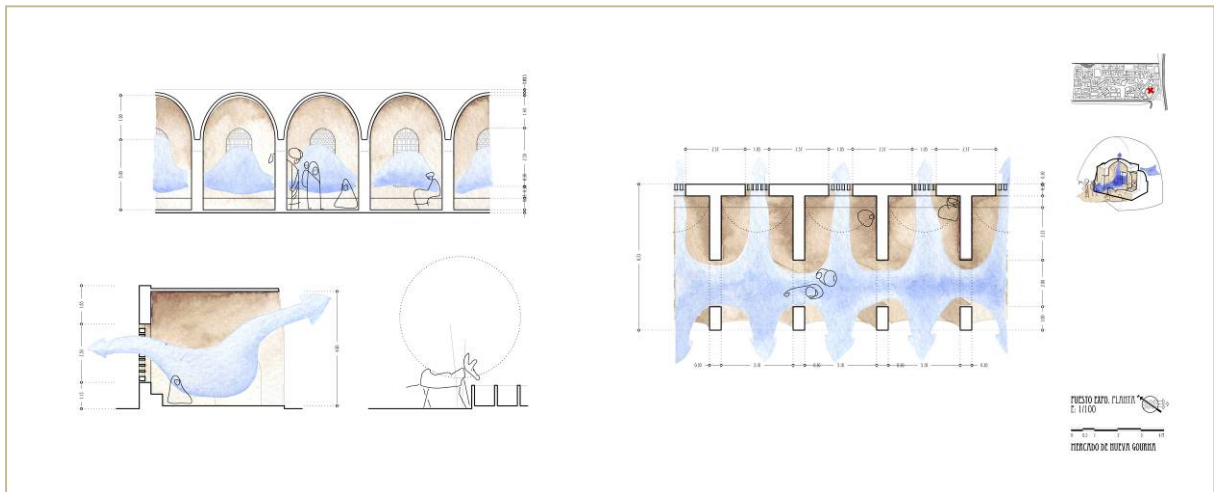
Secciones y planta del módulo tipo de puesto del mercado en Nueva Gourna. Redibujado por Javier Parra
